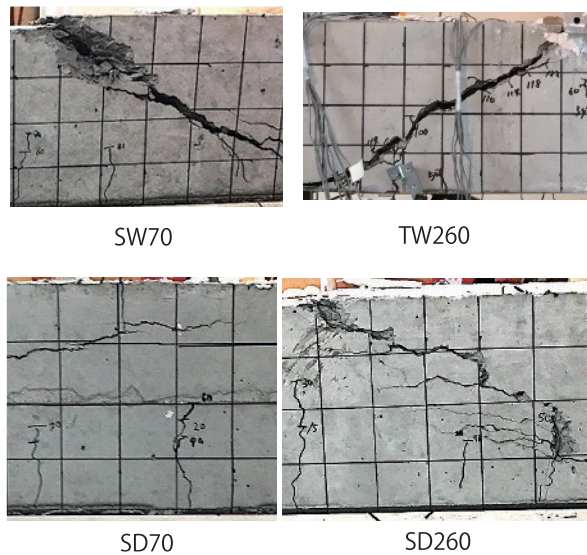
部材上面貫通部の斜めひび割れ性状
